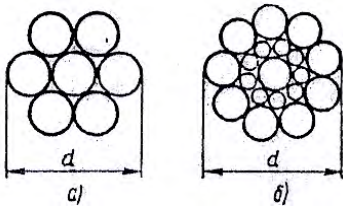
Схема поперечного сечения стальных арматурных канатов: а – К-7; б – К-19
